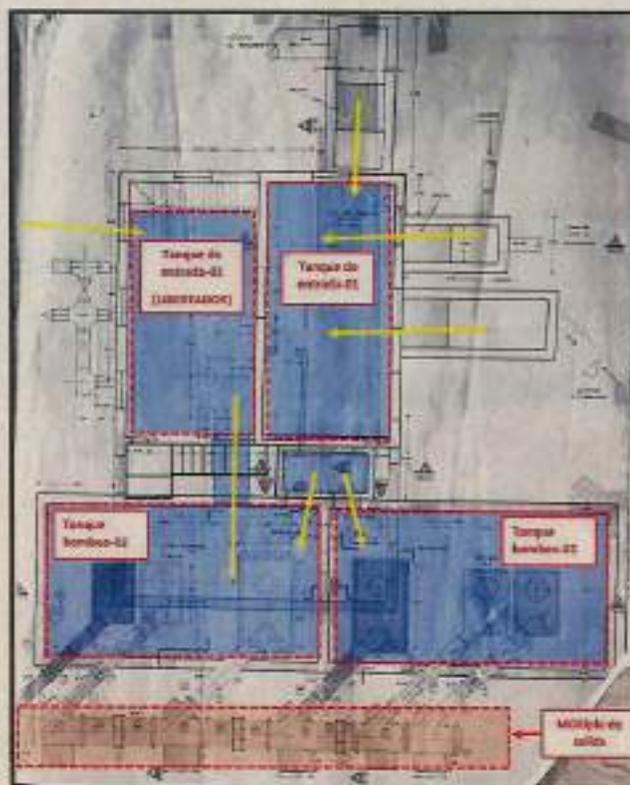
Esquema general estructuras EBAR – Distribución de tanques
